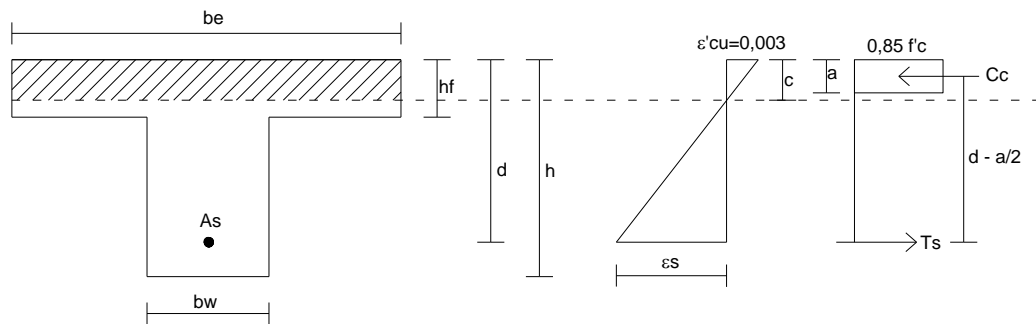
Balok Persegi, Balok "T" dan Diagram Tegangan Balok
